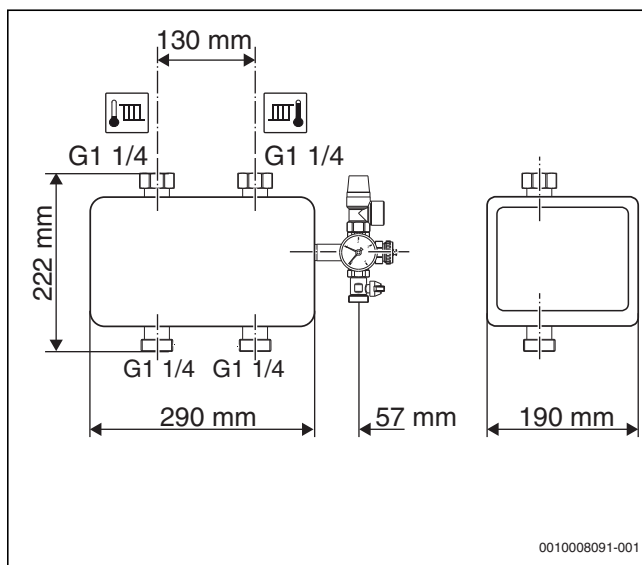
Abmessungen Wärmetauscherkennungs-Set mit integrierter Heizungspumpe (Maße in mm)
